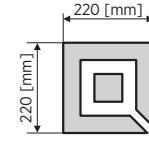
Tipo AP-5, dimensioni 220x220 [mm].
